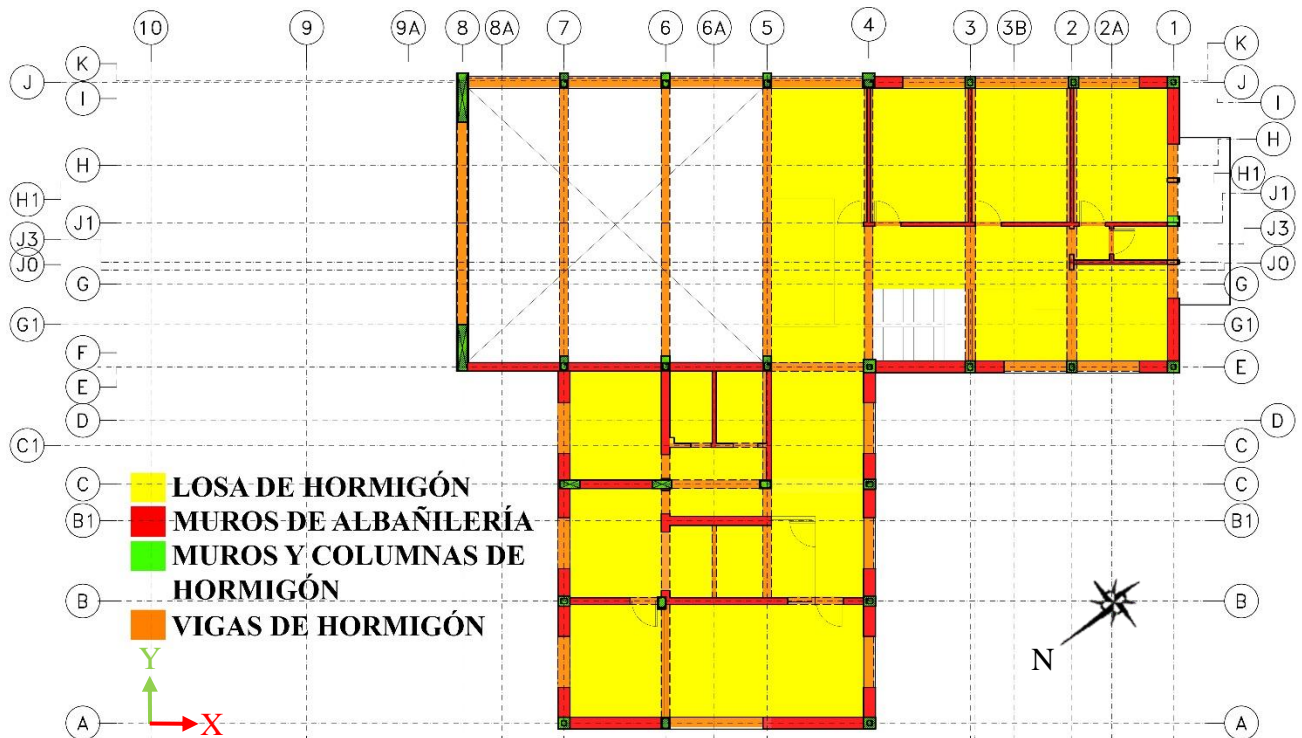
5 Planimetría, definición de elementos estructurales, segundo nivel.
